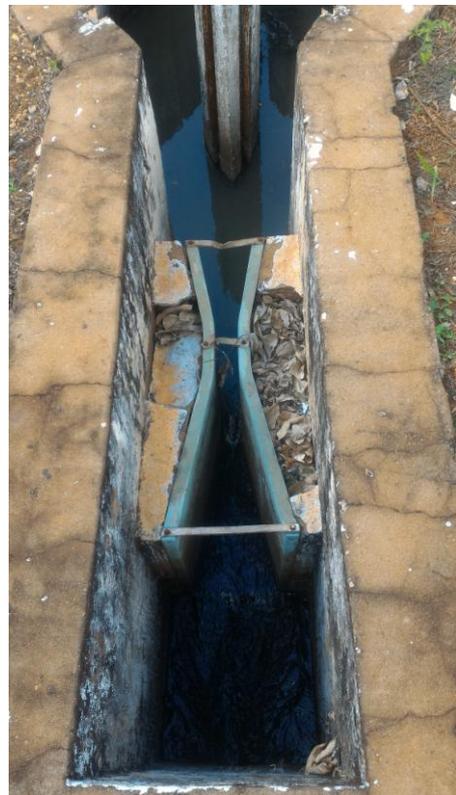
Calha Parshall, ETE Bairro Capelinha.
